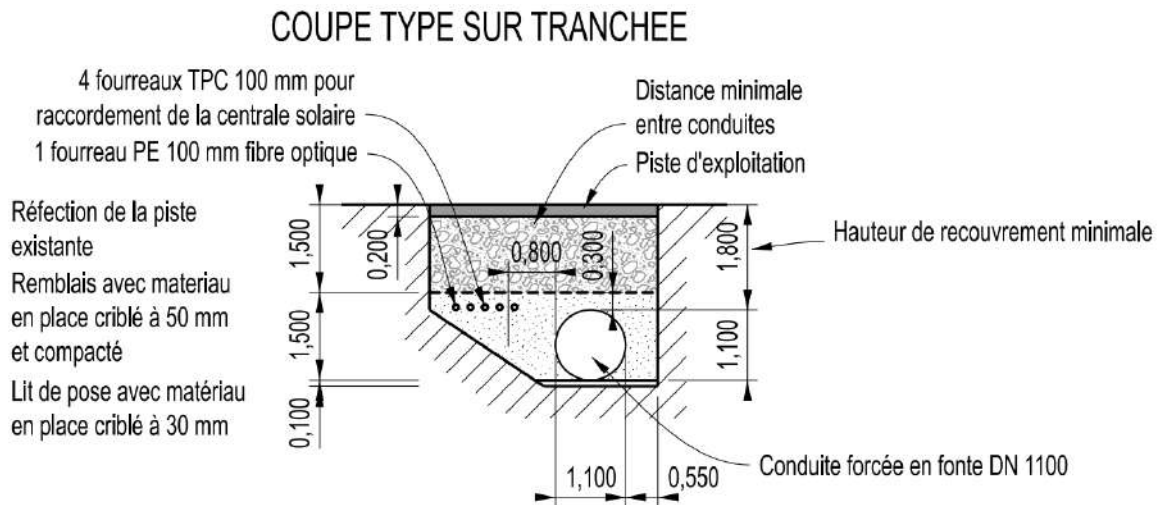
Coupe type de remblai de la conduite forcée (source : ISL Ingénierie)
